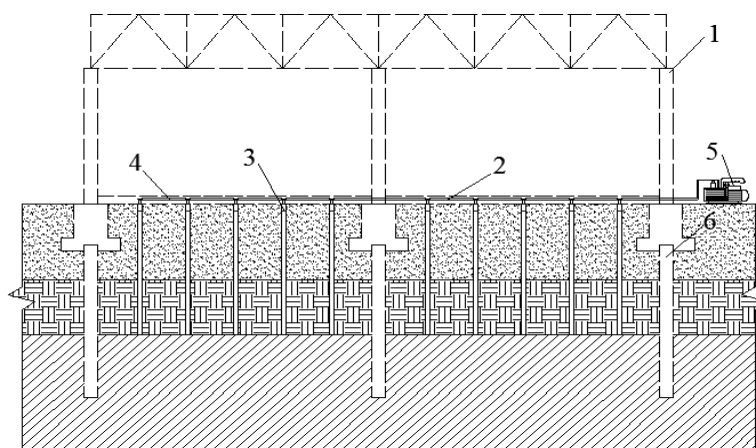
Схема для устройства пола по грунту: 1 – проектируемое промышленное здание; 2 – монолитный бетонный пол; 3 – ленточная дрена; 4 – магистральный трубопровод; 5 – вакуумный насос; 6 – проектируемый свайный фундамент под колонны каркаса
